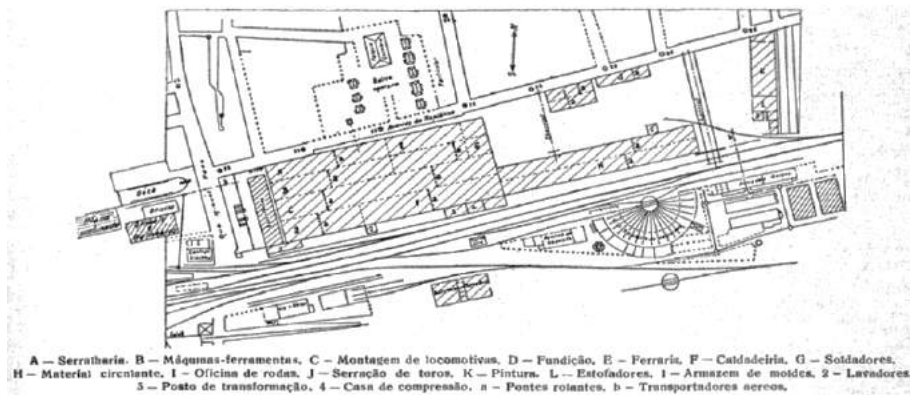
PLANTA GERAL DAS OFICINAS GERAIS COM A DIVISÃO DAS ÁREAS DE TRABALHO
